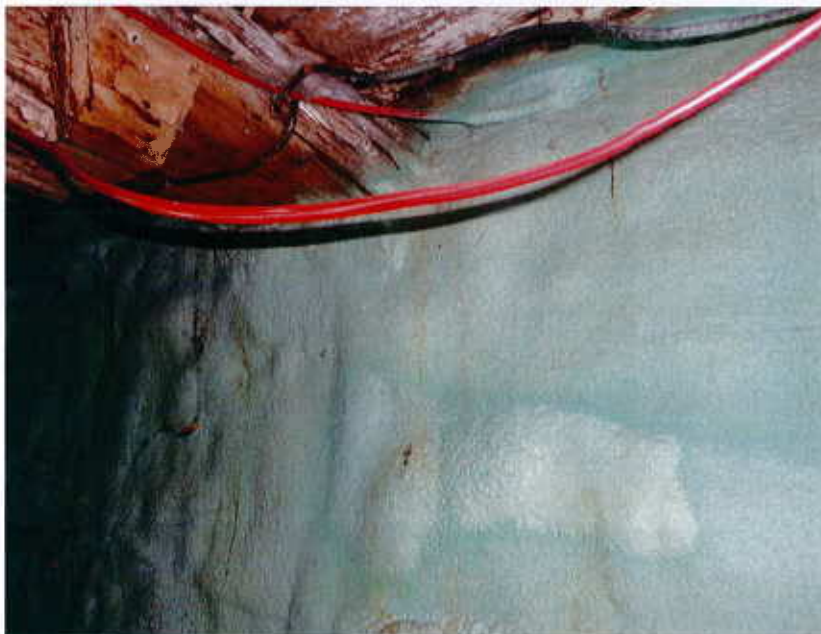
Le mur de fondation en pierre à l'intérieur à été recouvert d'un uréthane giclé sur toute sa surface.
